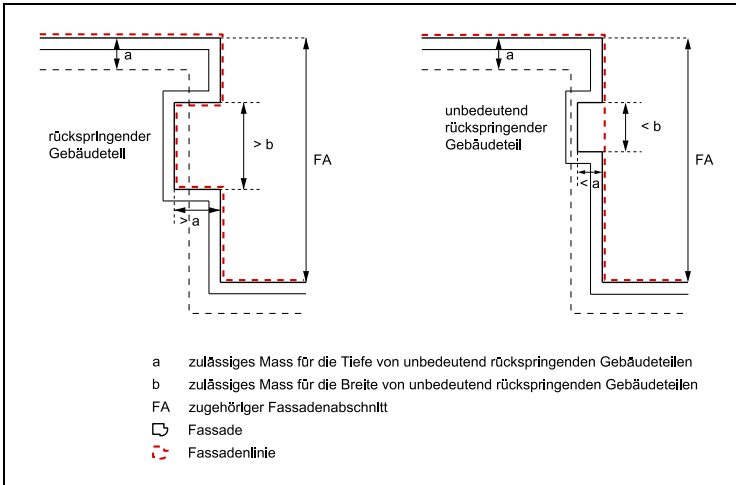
Projizierte Fassadenlinie (§ 6 b ABV)
